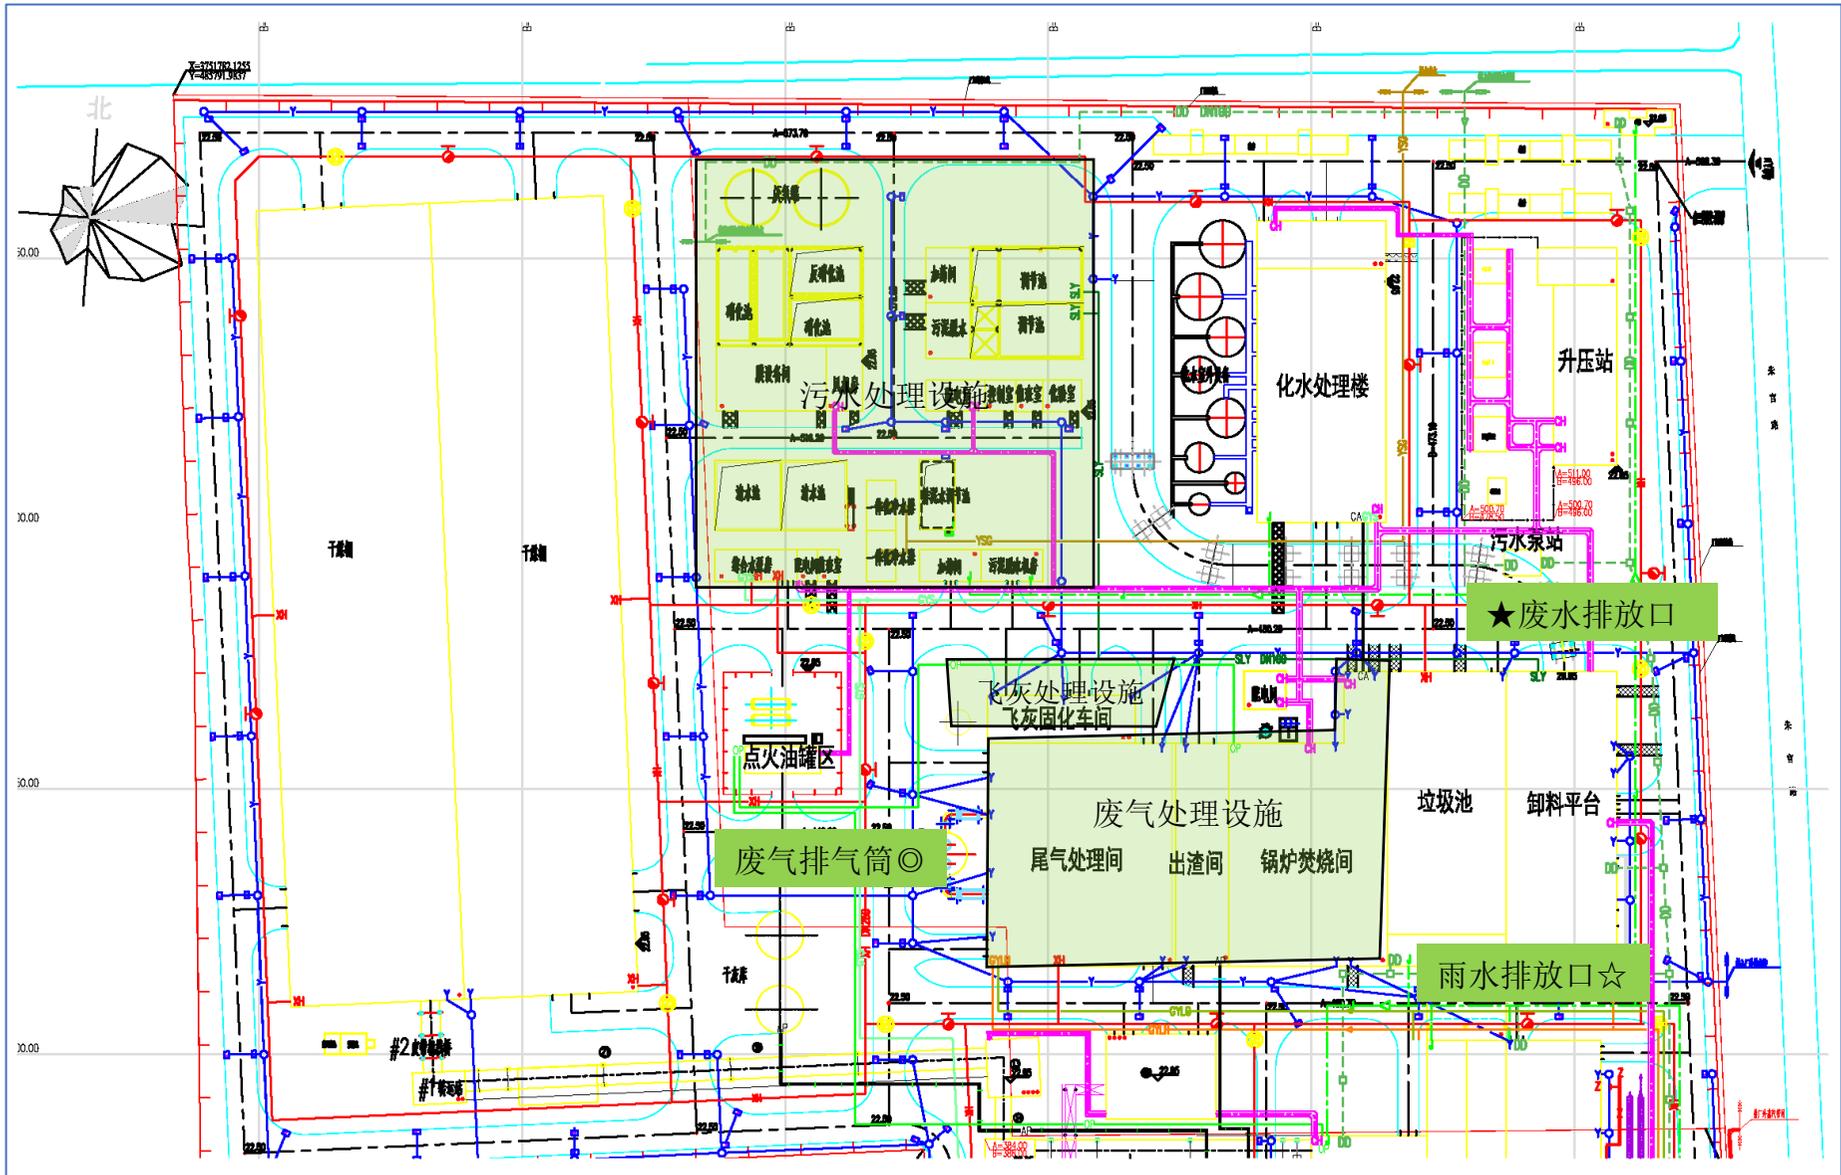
项目实际平面布置图及主要污染源点位示意图 (★为废水排口, ☆为雨水排口, ◎为废气排口)
